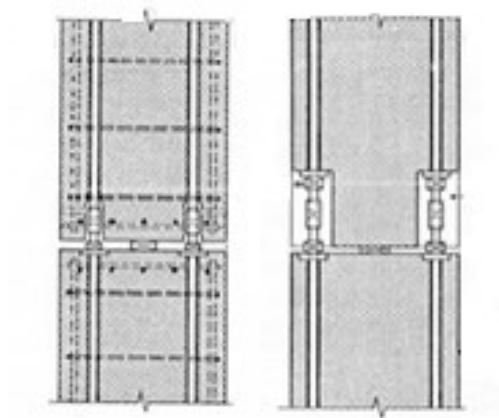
Utilização da pós-tensão na união de pilares pré-fabricados (STUPRÉ, 1981).
